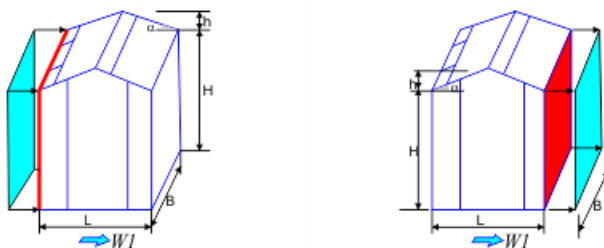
Схема приложения ветровой нагрузки на боковые стены
